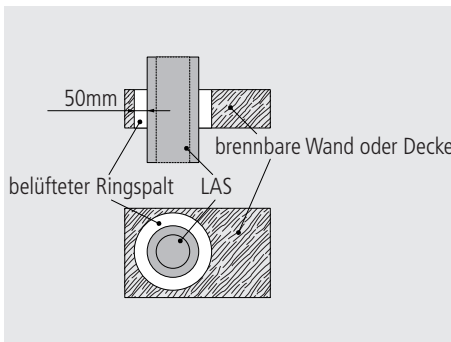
Wand- und Deckendurchführung mit Ringspalt
